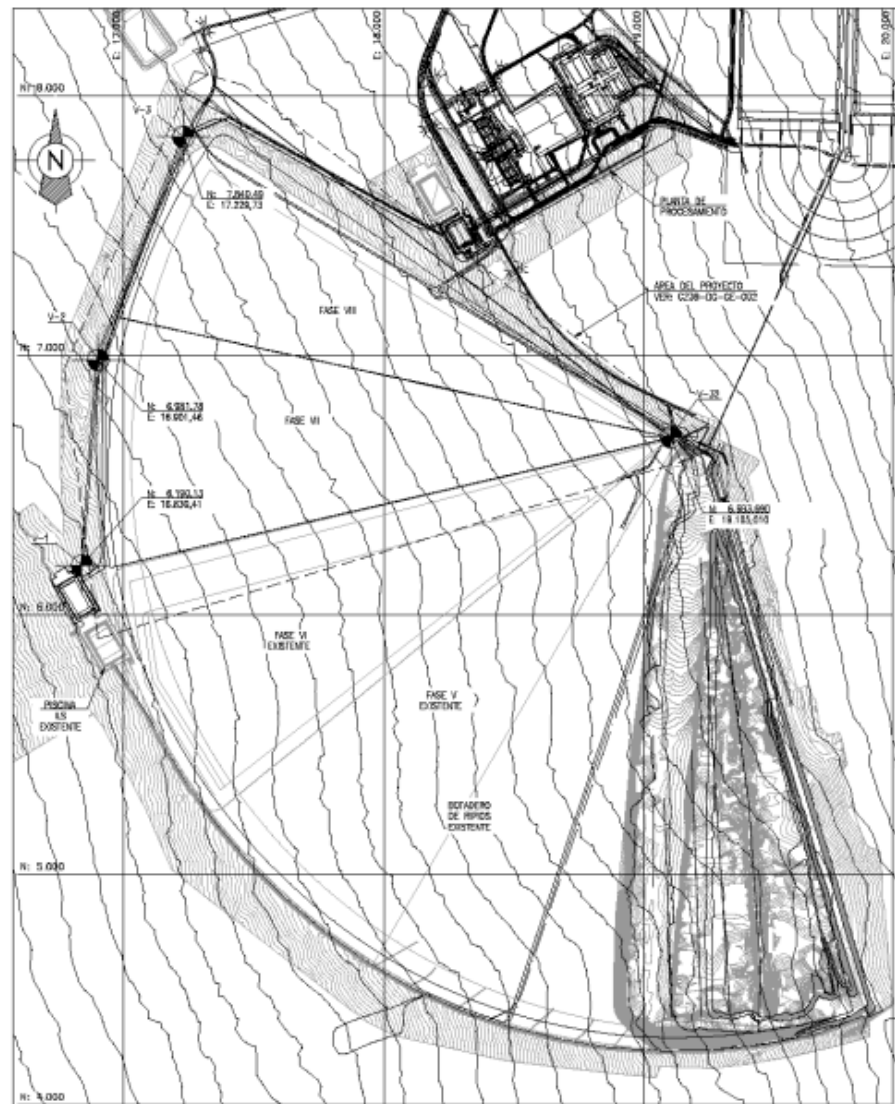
DISPOSICIÓN GENERAL PROYECTO – PLOT PLAN
